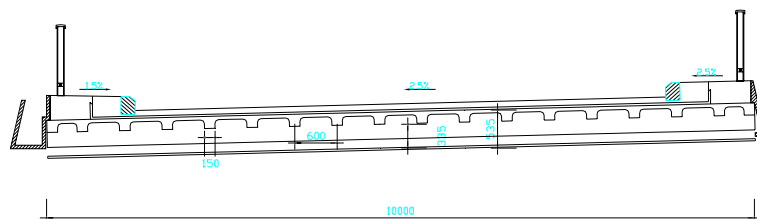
Coupe transversale - solution 10m - Dalle BFUP gaufree-échancree et matériau composite
